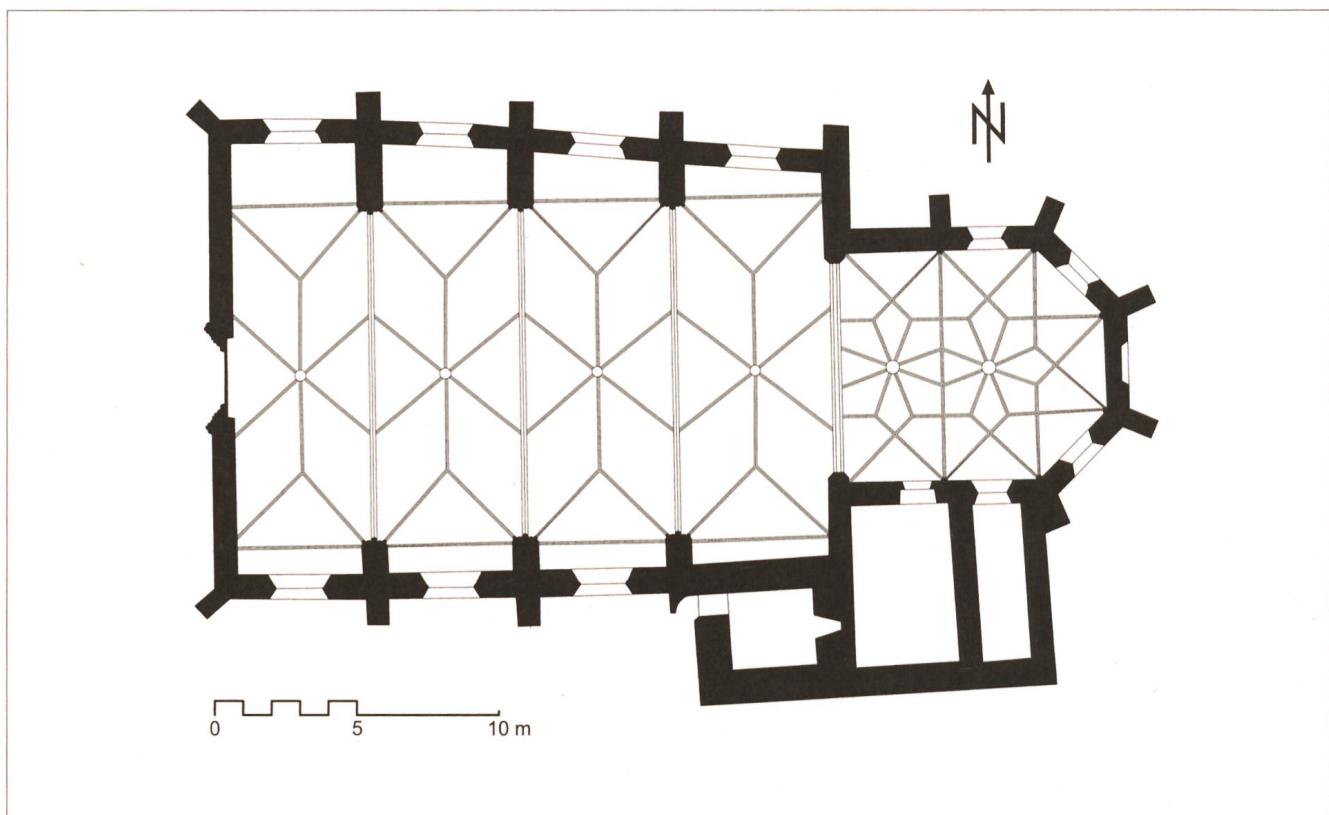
Grundriss der Stiftskirche von Poschiavo aus Laserscans und tachymetrischem Aufmass erstellt.
